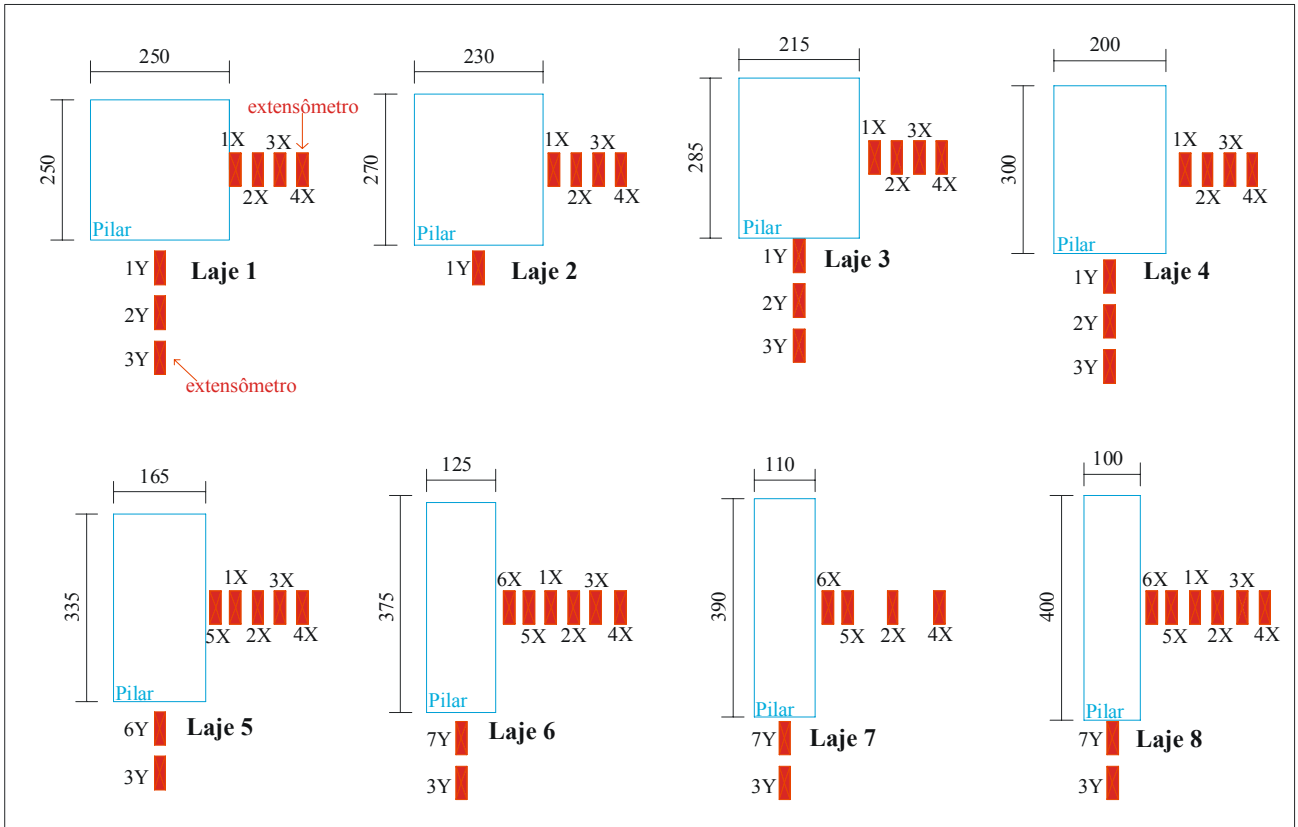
Posição dos extensômetros no concreto - (mm)
